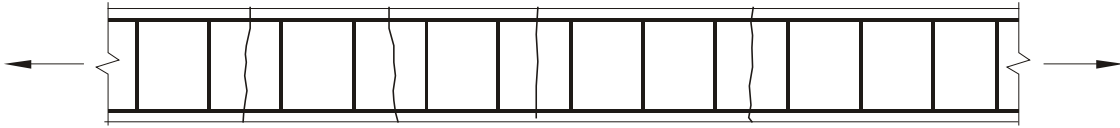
Fissuras provocadas por tração axial
